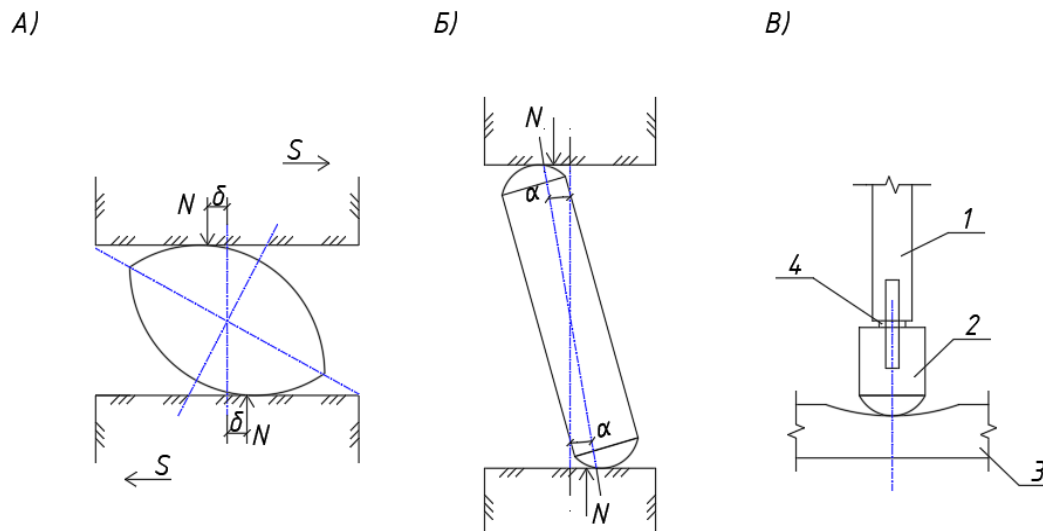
Кинематические опоры для сейсмоизоляции зданий:
